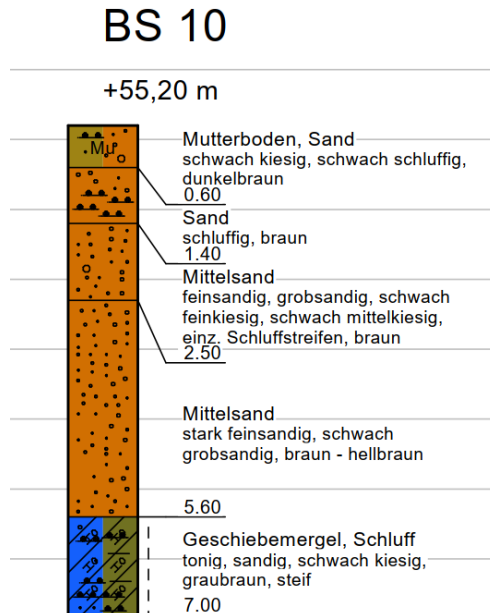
Ausschnitt aus dem Baugrundgutachten. Profil BS 10 (Quelle: Büro GBU 04/2023)
